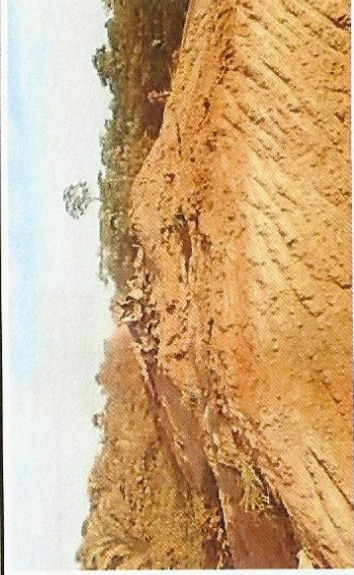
Restos de Bueiro Metálico na faixa de domínio.
